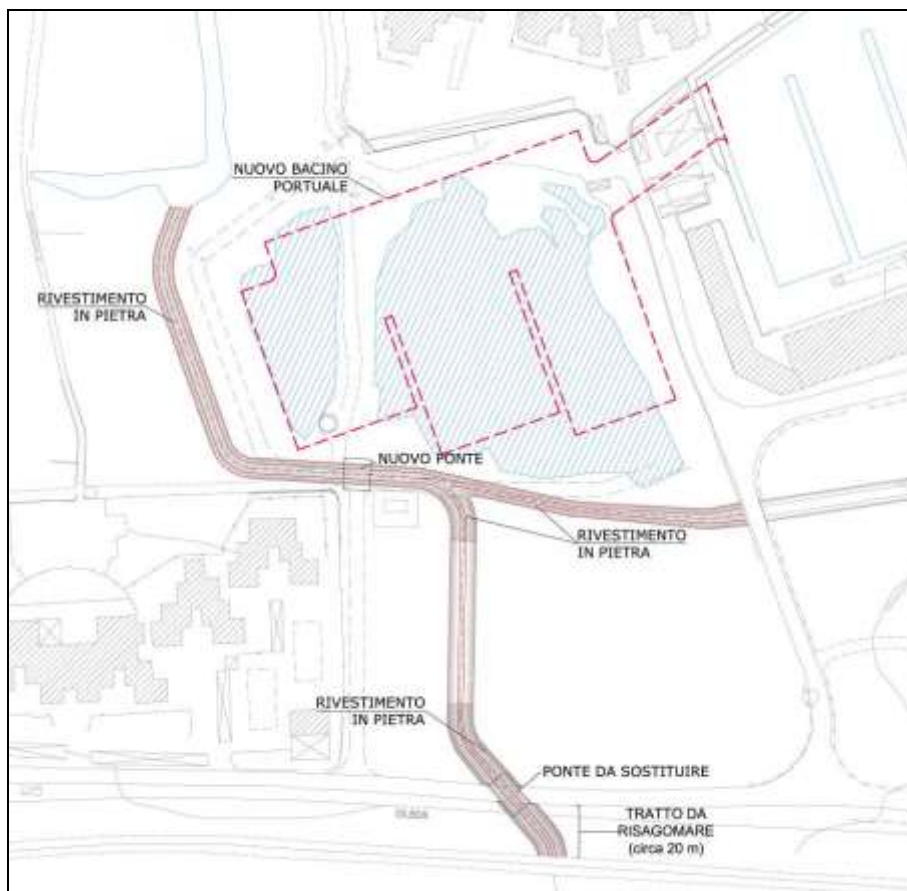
Elementi di massima del progetto del lotto funzionale 1
